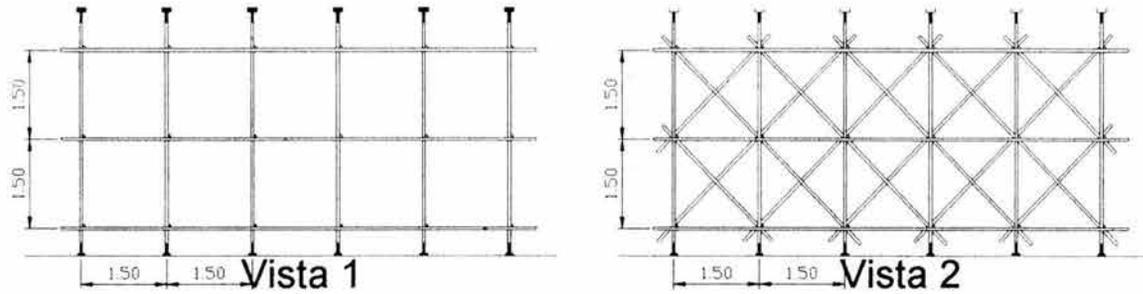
Obra falsa para las losas a la Elev. 207.00 y 211.00.
